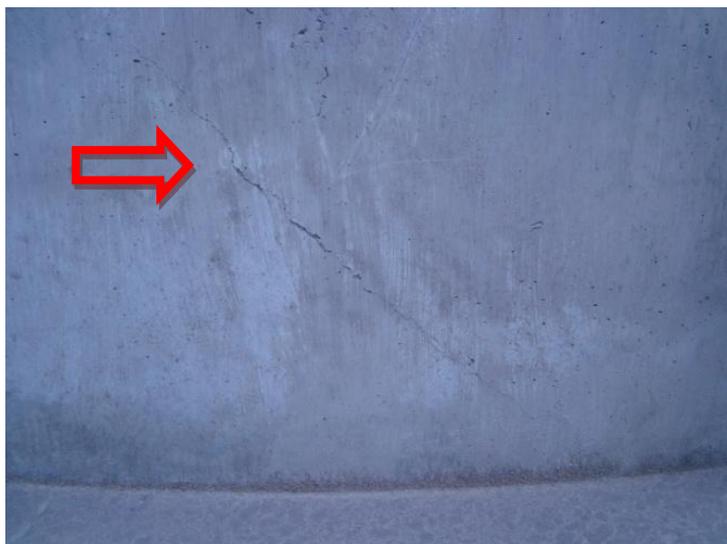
Fissura por insuficiência estrutural.
